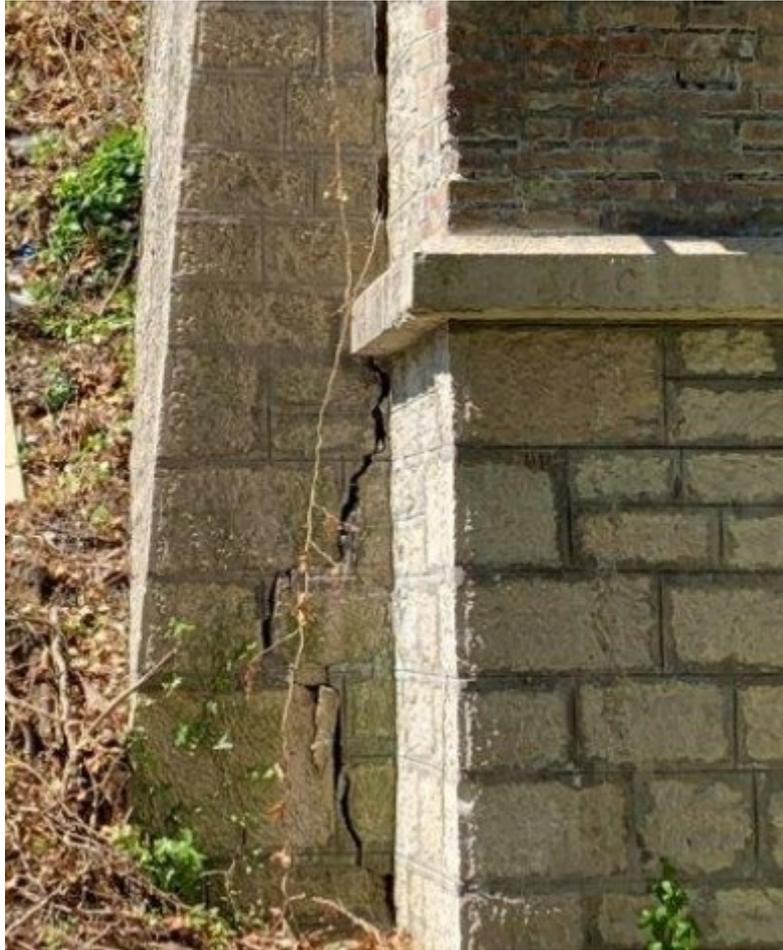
Lesioni verticali diffuse nel paramento murario del muro di risvolto delle spalle del ponte
